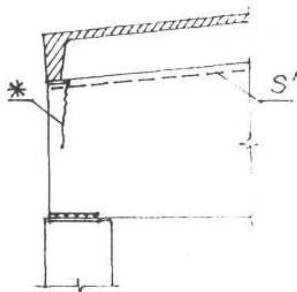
Схема образования вертикальных трещин вблизи торцов балок или ферм, где \* – трещина, S' – верхняя арматура.
